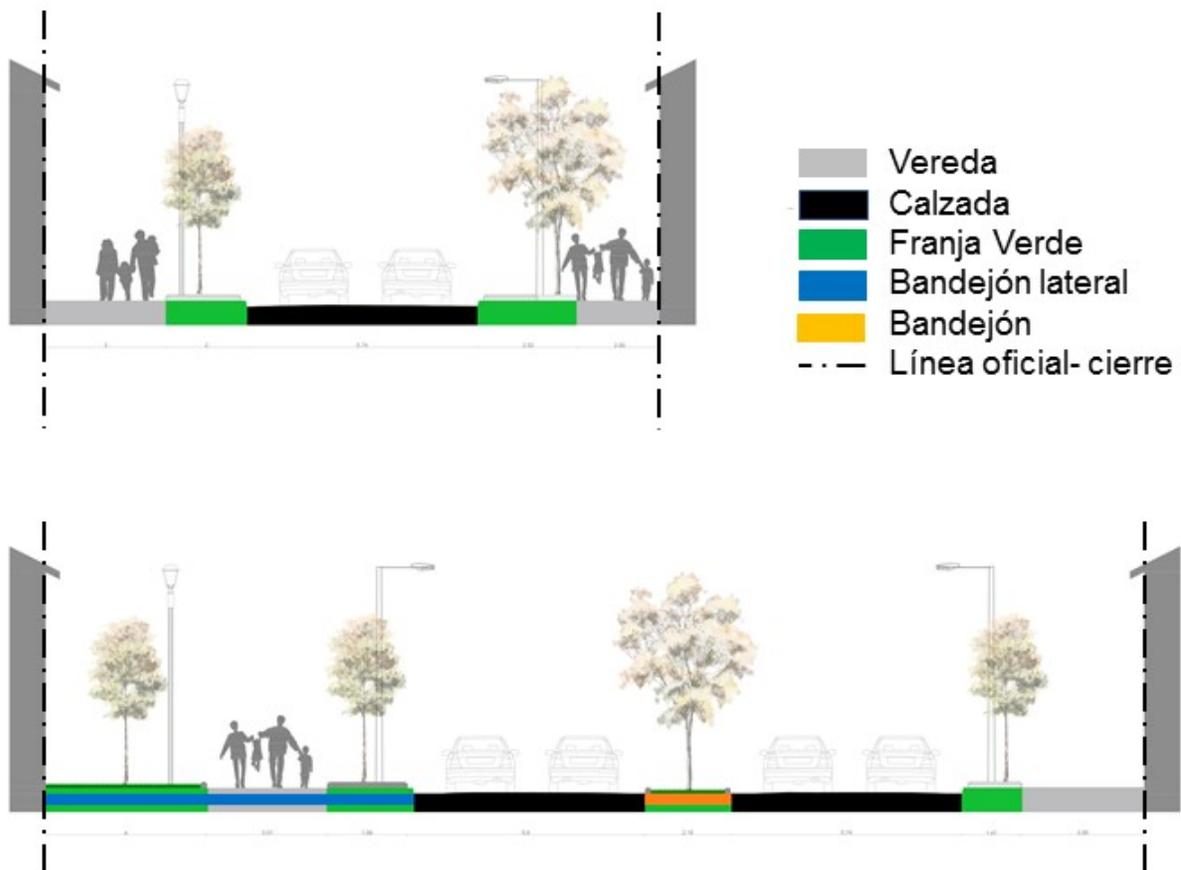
Perfiles de calle tipo. Elaboración SECPLAC.
